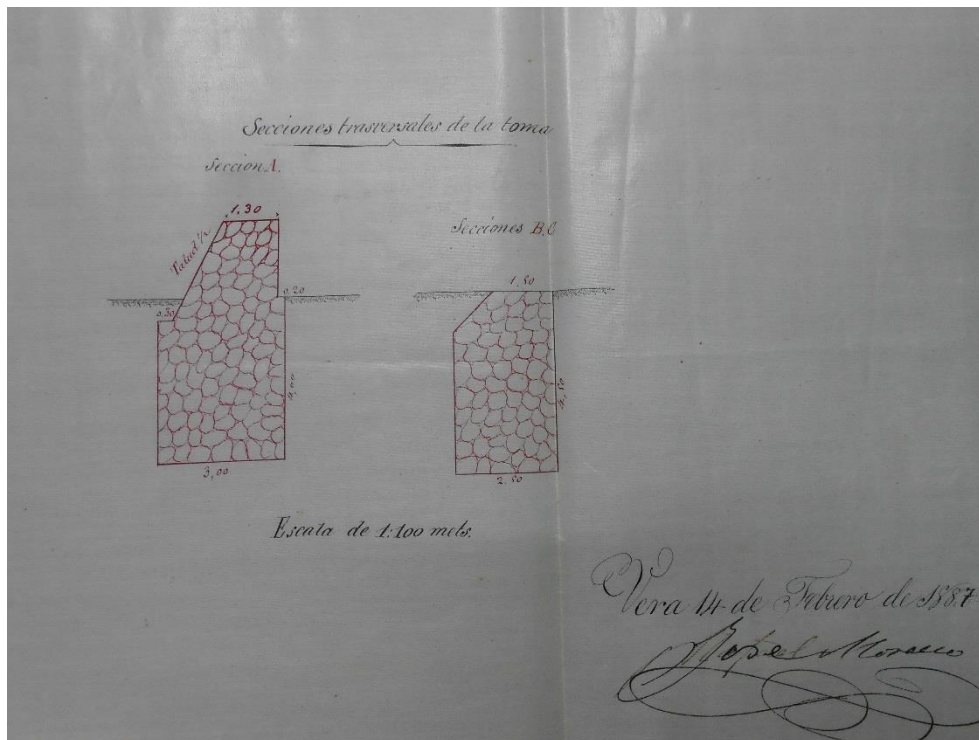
Perfil transversal del muro de la Presa de La Jara.
